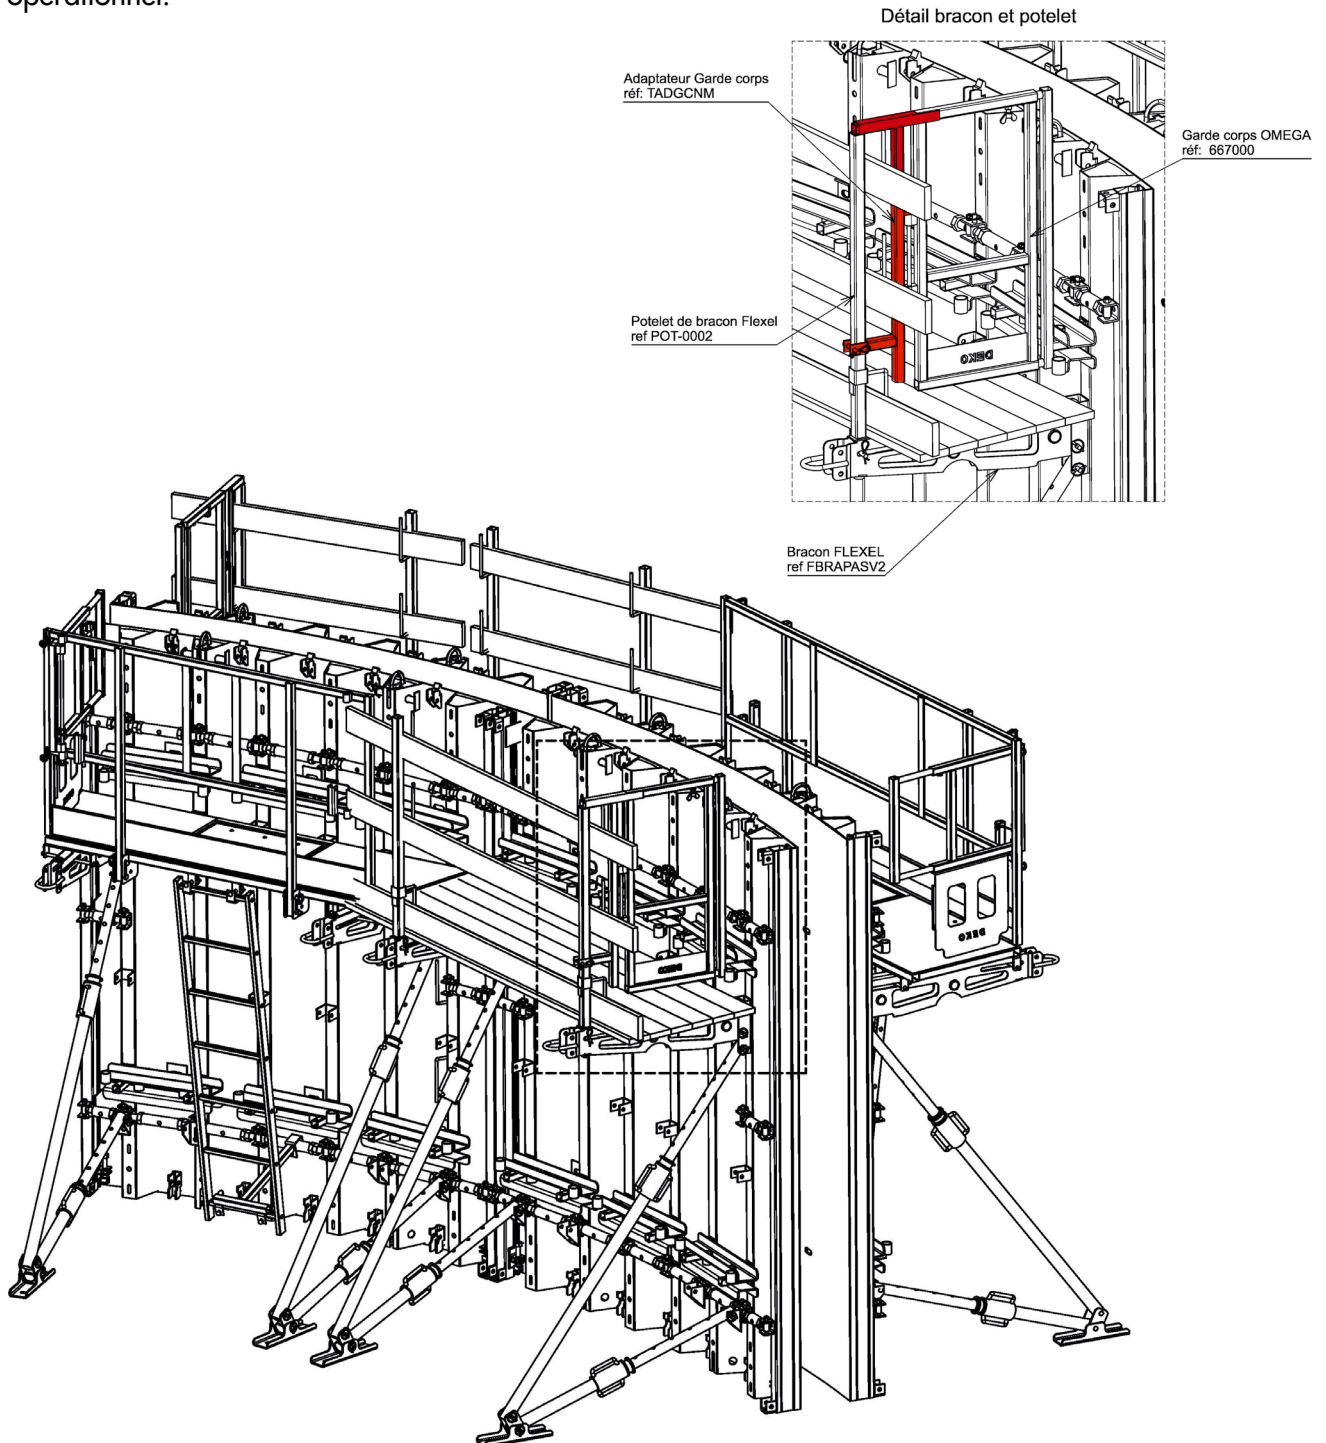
Vue sur une sécurité mixte, passerelles de bétonnage avec trappe + bracons et potelets
